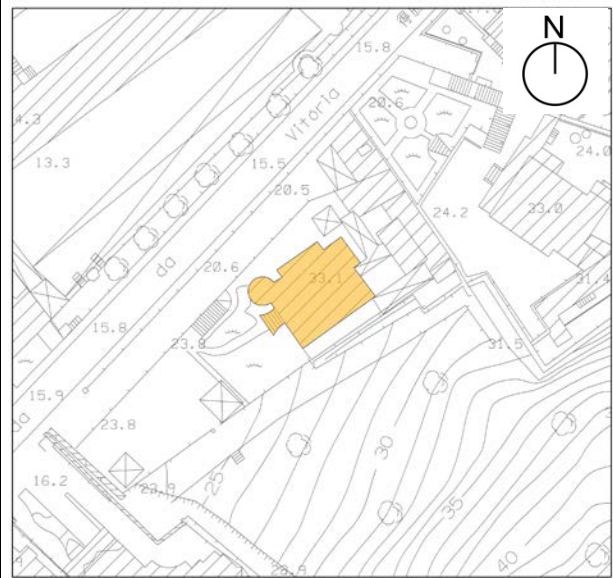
Planta de implantação do imóvel em vias de classificação
